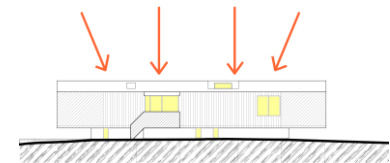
Ingreso del sol por la fachada Oeste. Fuente: Autor.
